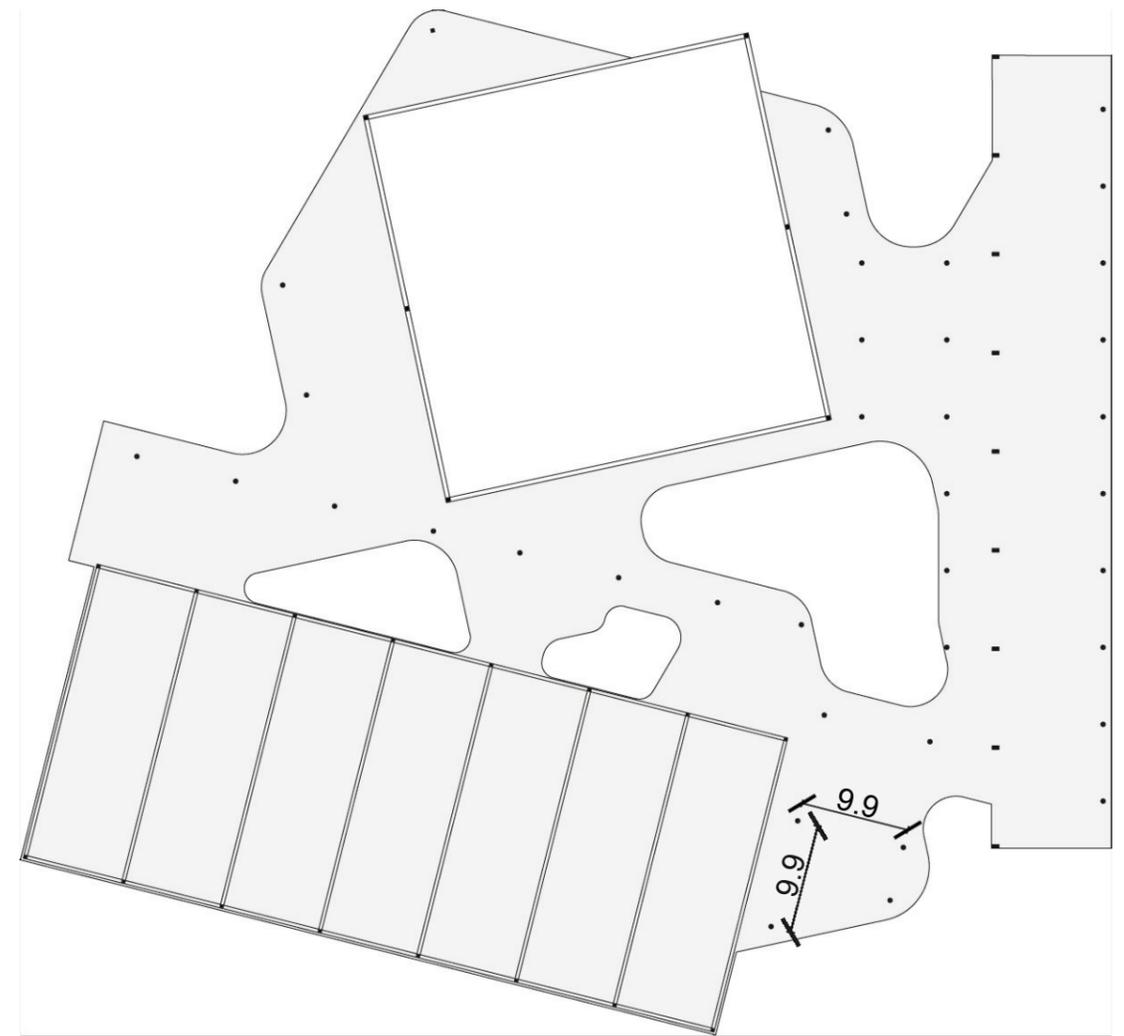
Grundriss „Zwischenplatten“ - 2. Obergeschoss
